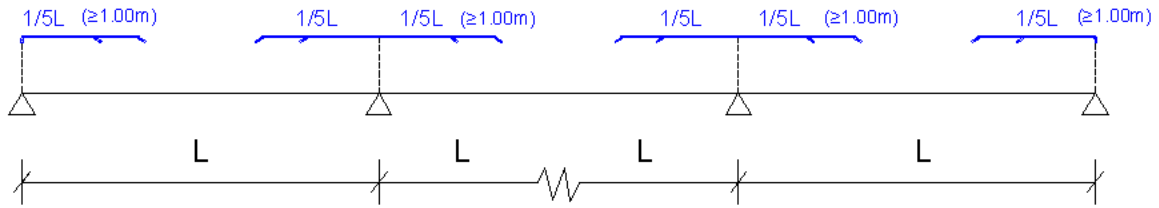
Disposição das armaduras de momentos negativos em vista transversal.
